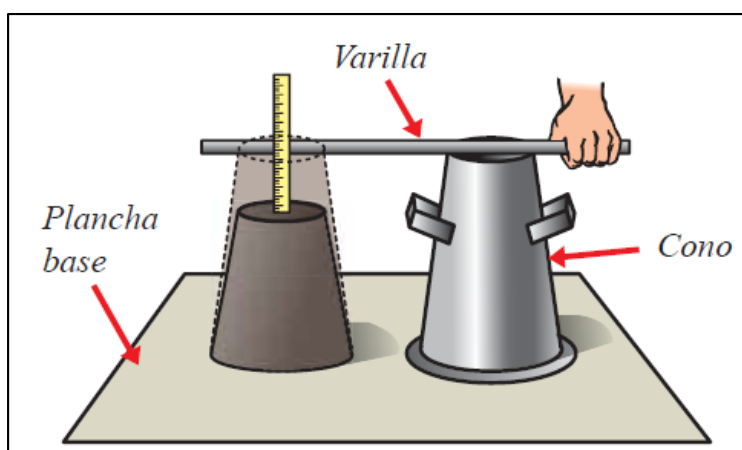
prueba del “slump” mide la “Trabajabilidad” del concreto
